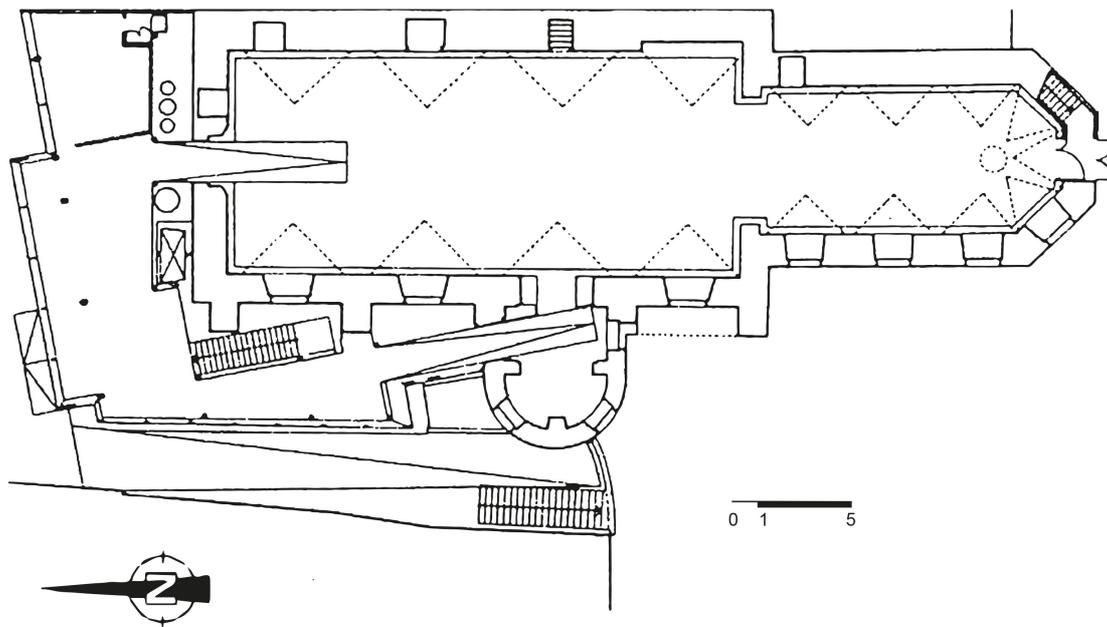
Grundriss Oberes Geschoß
